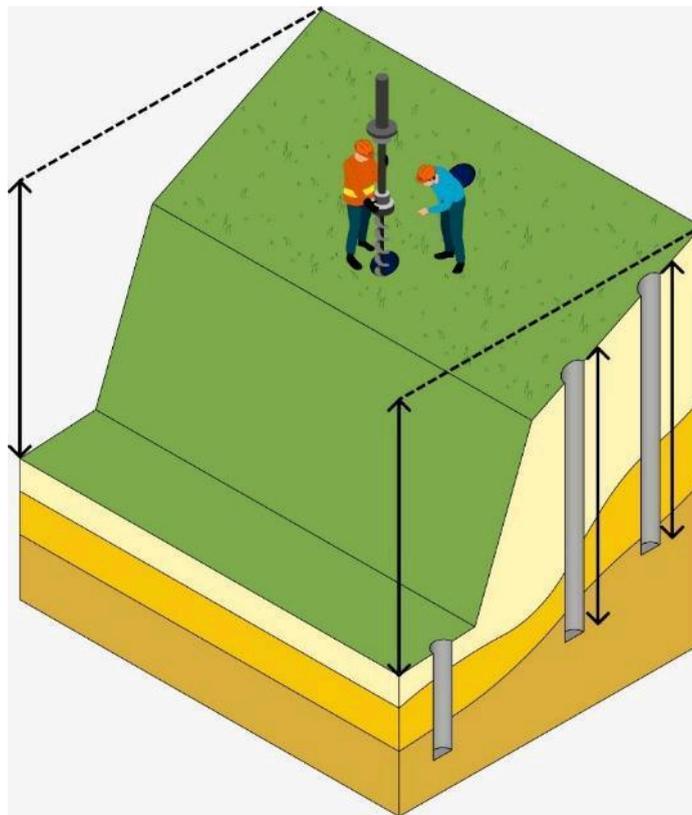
Croqui esquemático dos pontos preferenciais de localização das sondagens em relação ao perfil do talude e definição da profundidade pretendida (Fonte: PMRR)
